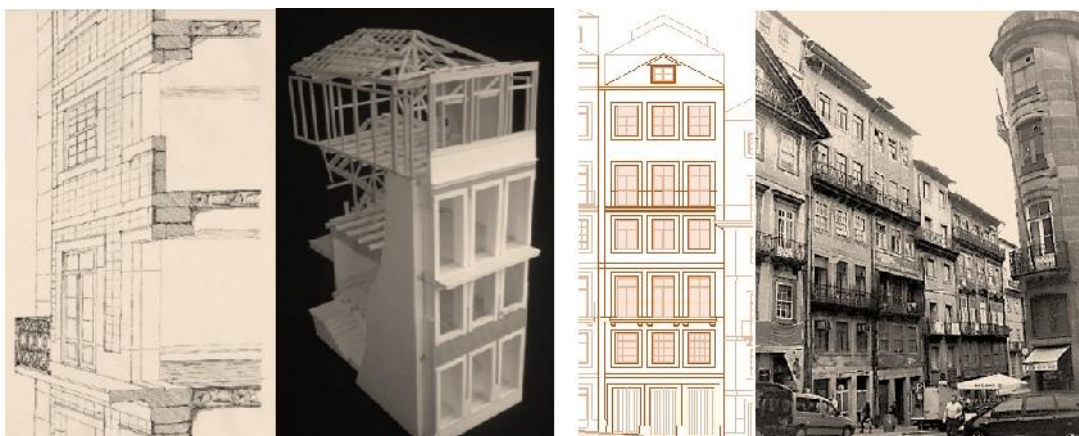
Características constructivas y estructurales⁷. Fachada representativa⁸ e imagen de calle.
